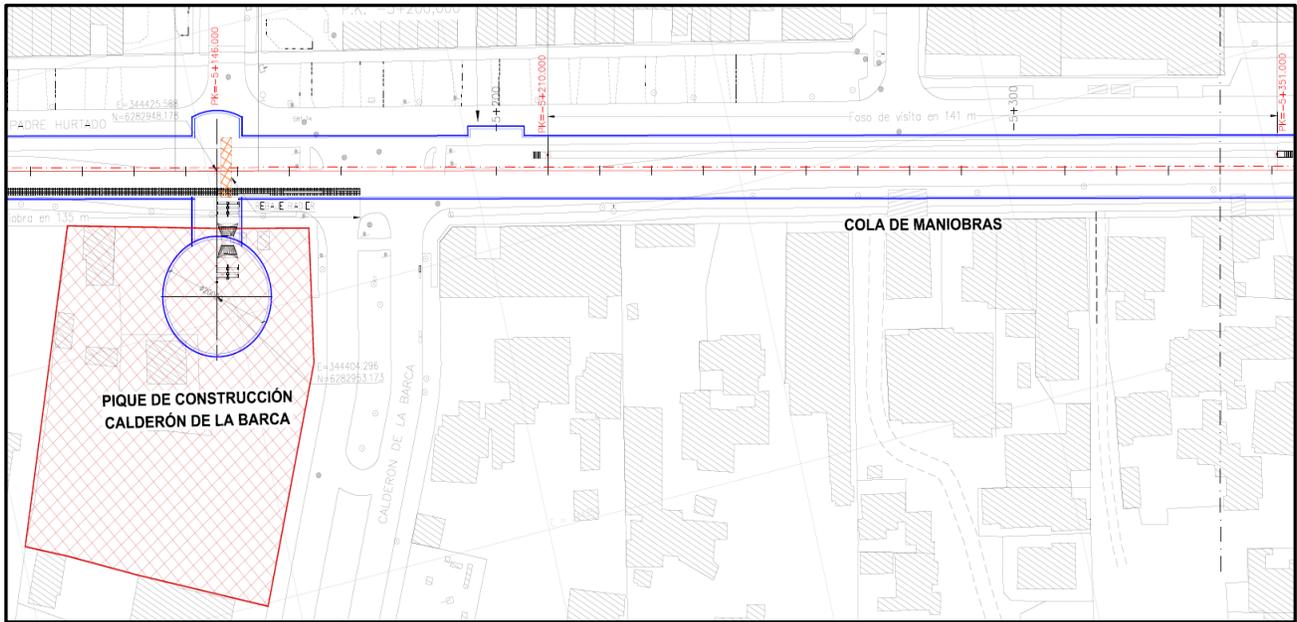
Planta Emplazamiento Pique Calderón de la Barca y Túneles Interestación (Túnel Cola de Maniobras)
